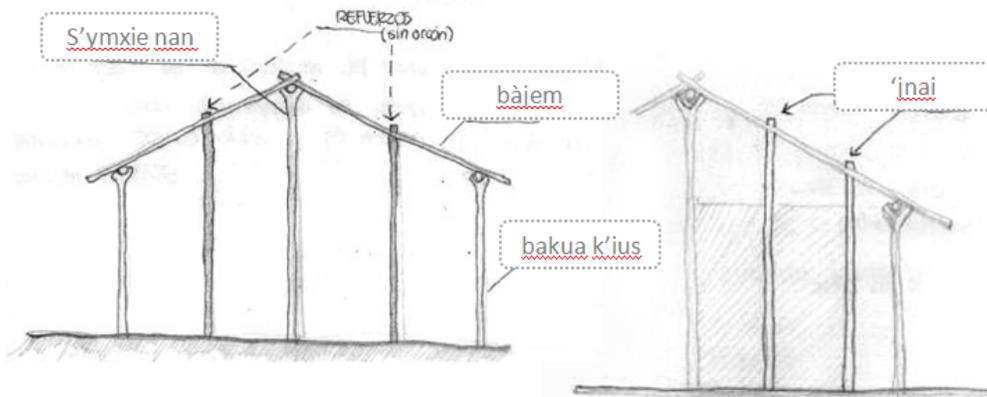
Detalle y nomenclatura de la estructura secundaria (refuerzos).
